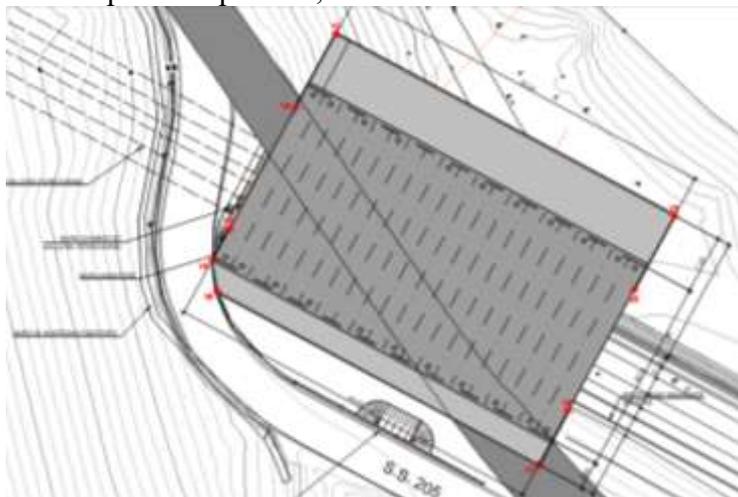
Planimetria impalcato nodo 1 (Fonte: Lista di controllo)
